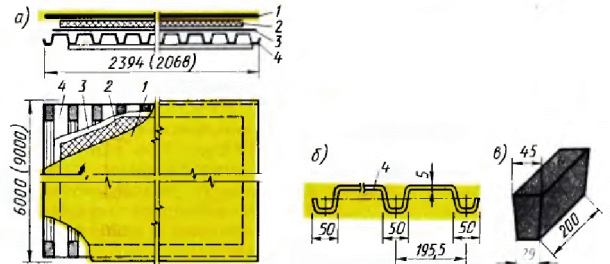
Конструкция панели покрытия из оцинкованных стальных профилей: а — панель покрытия, б — оцинкованные профили, в — бетонный вкладыш в гофры по краям стального настила кровли; 1 — кровельный ковер, 2 — теплоизоляция, 3 — пароизоляция, 4 — профилированный настил
